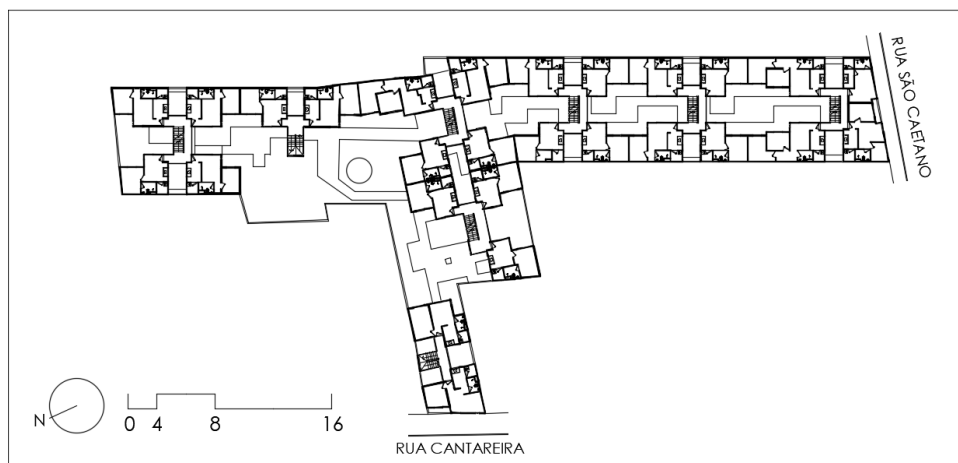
Planta baixa do Pavimento Tipo do Residencial São Caetano.
